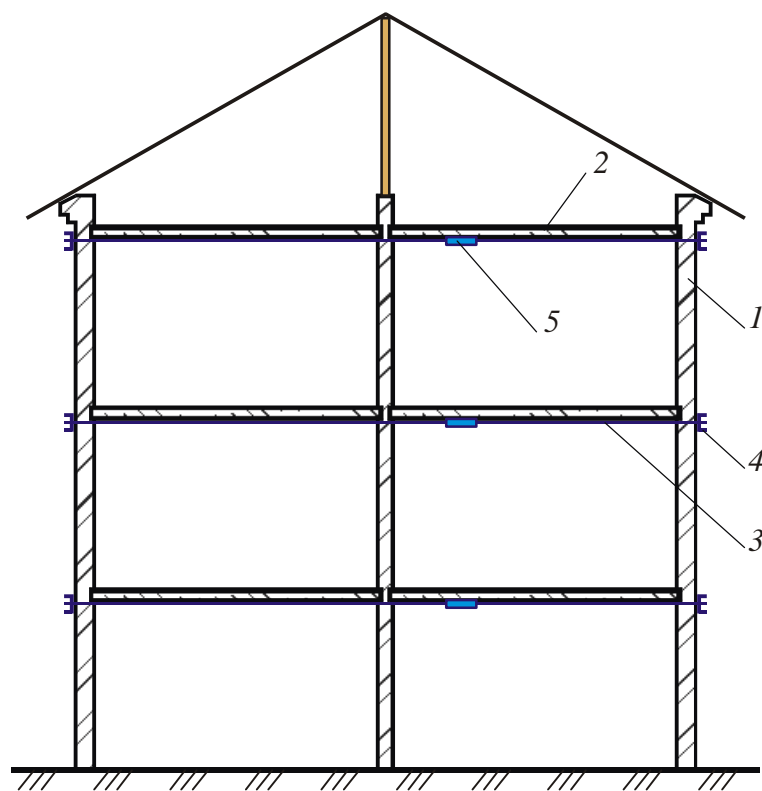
Усиление стен стальными тяжами, устанавливаемыми под перекрытия:
